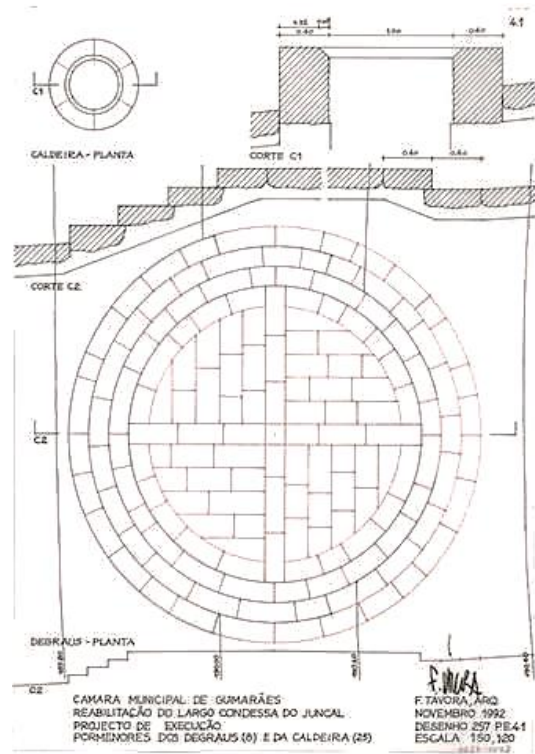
Rotunda que evoca a Igreja de S. Paio (demolida); Planta e Corte da rotunda. Fonte: Autor; Arquivo | Fundação Instituto Marques da Silva.
